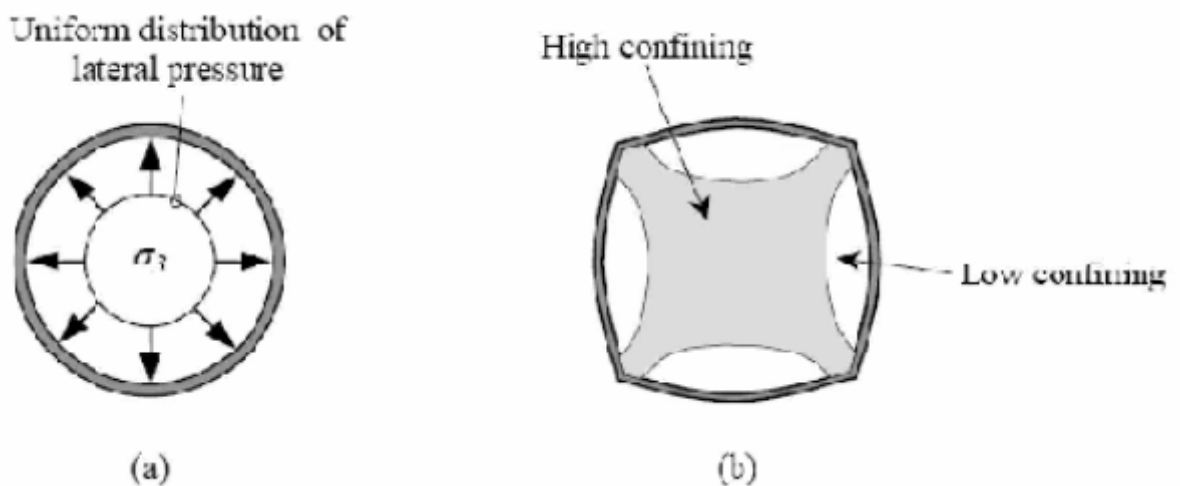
Béton efficacement confiné pour les poteaux en béton armé par convention et poteaux mixtes remplis de béton [26].
